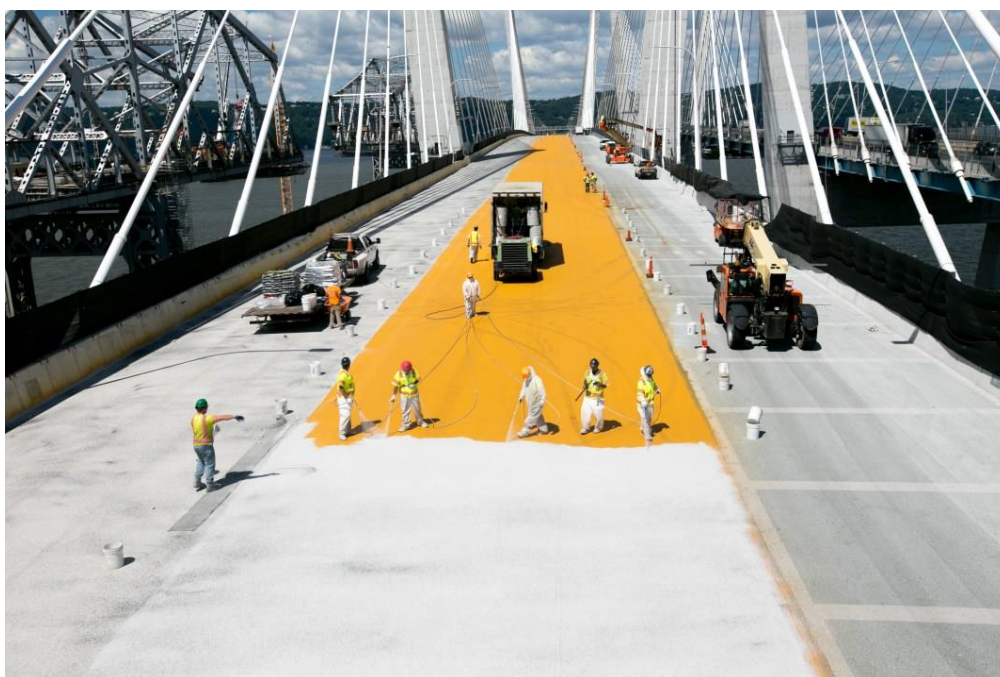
Использование двухцветной системы укладки гидроизоляции
